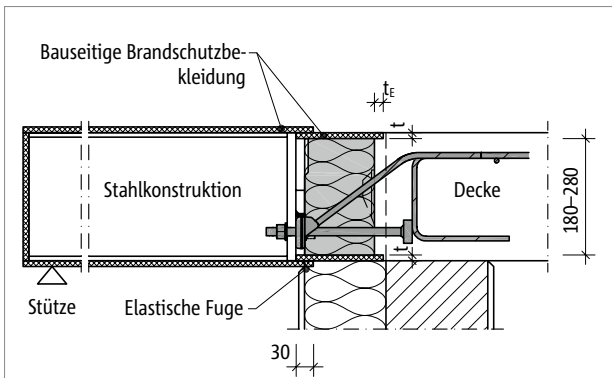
Schöck Isokorb® XT Typ SQ: Bauseitige Brandschutzbekleidung für den Isokorb® und die Stahlkonstruktion; Schnitt
